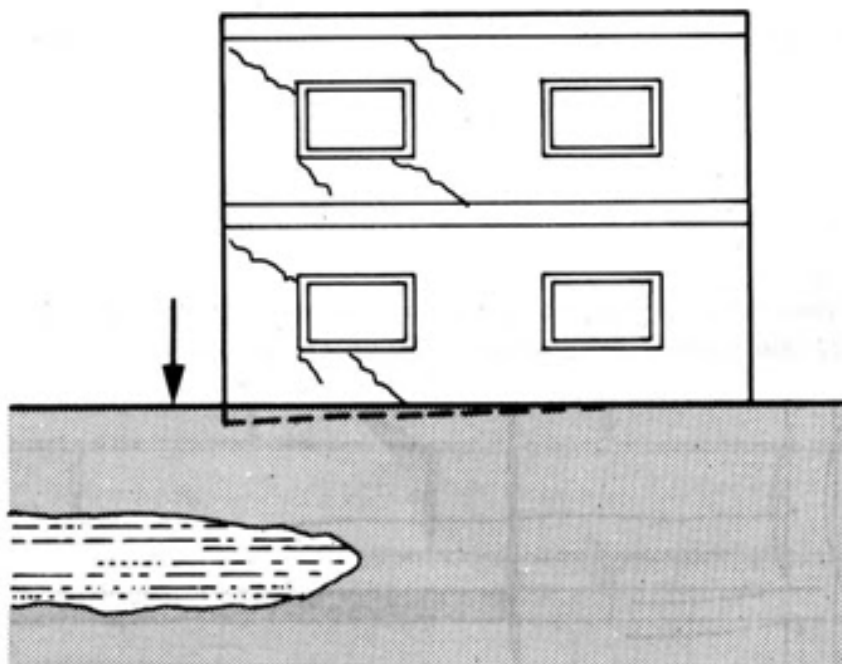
Fissuras devidas a assentamentos diferenciais dos apoios
